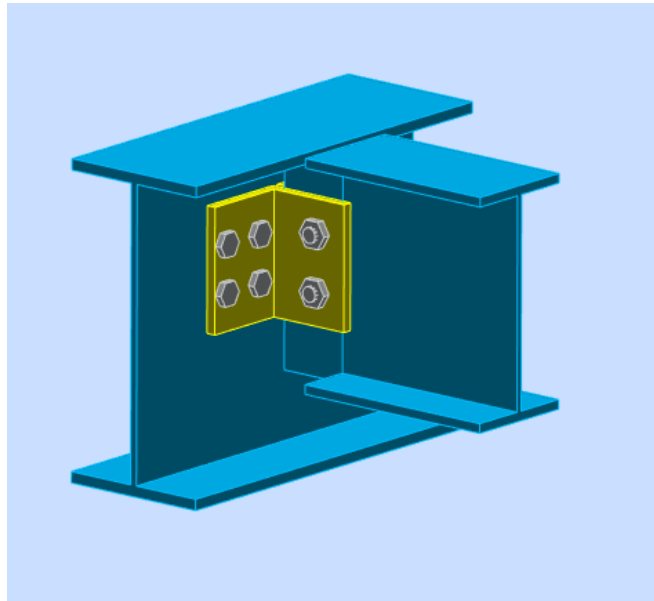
Schéma de l'assemblage poutre – solive.
